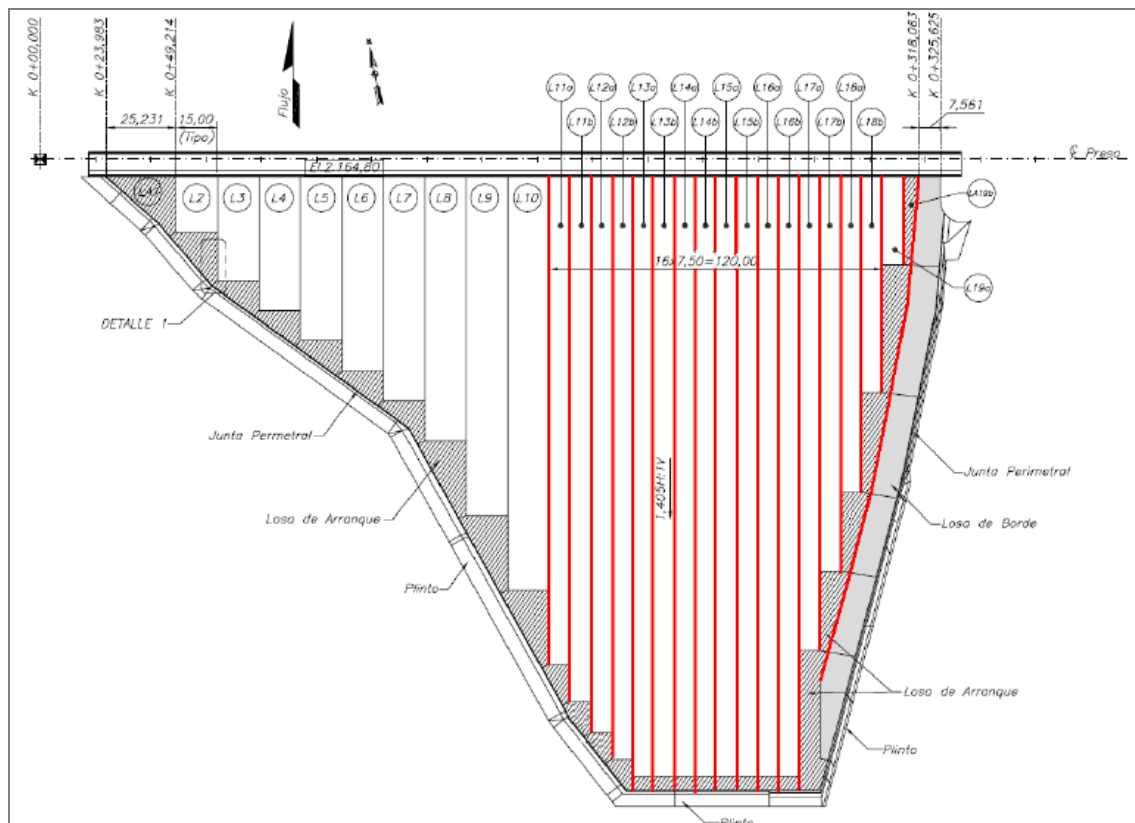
Elementos de hormigón armado de la cara de la Presa.
